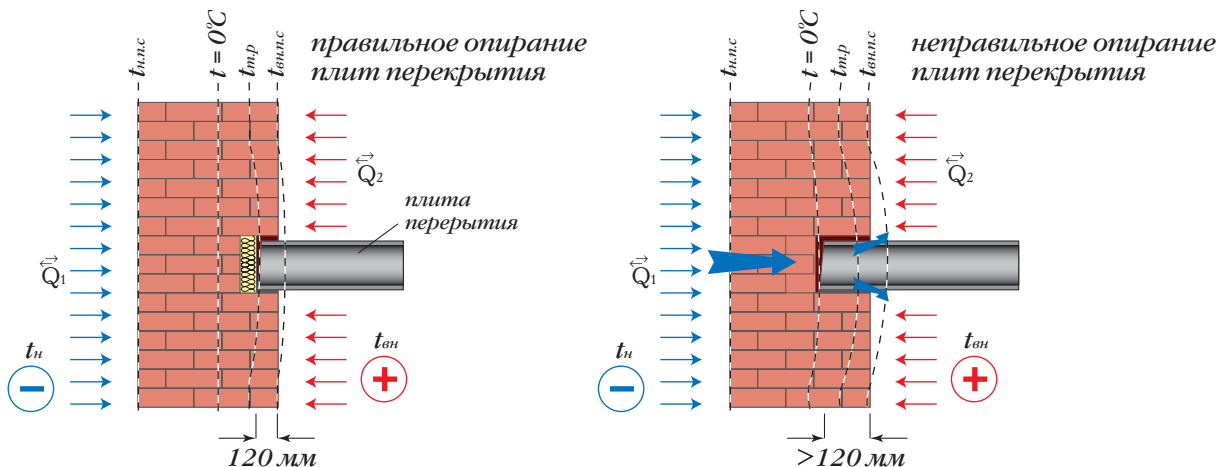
Глубокое опирание плиты перекрытия образует «мостик холода»
